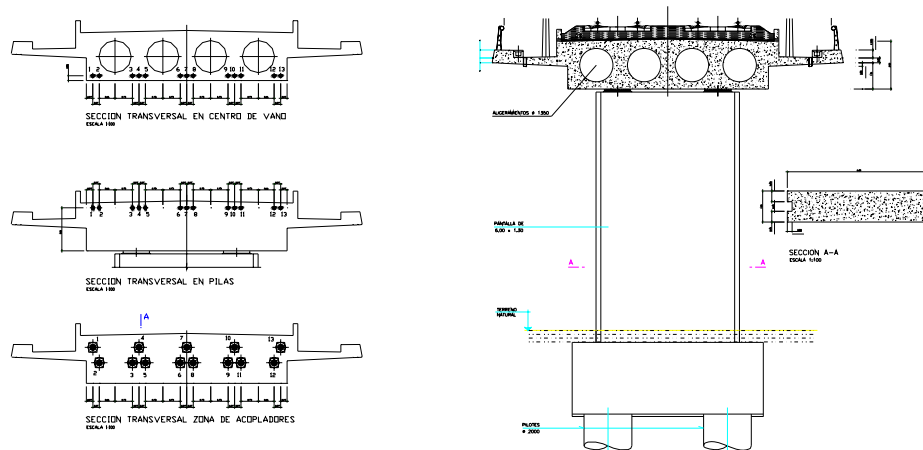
Pilares e tabuleiro do Viaduto de Cornella – Barcelona - Espanha
